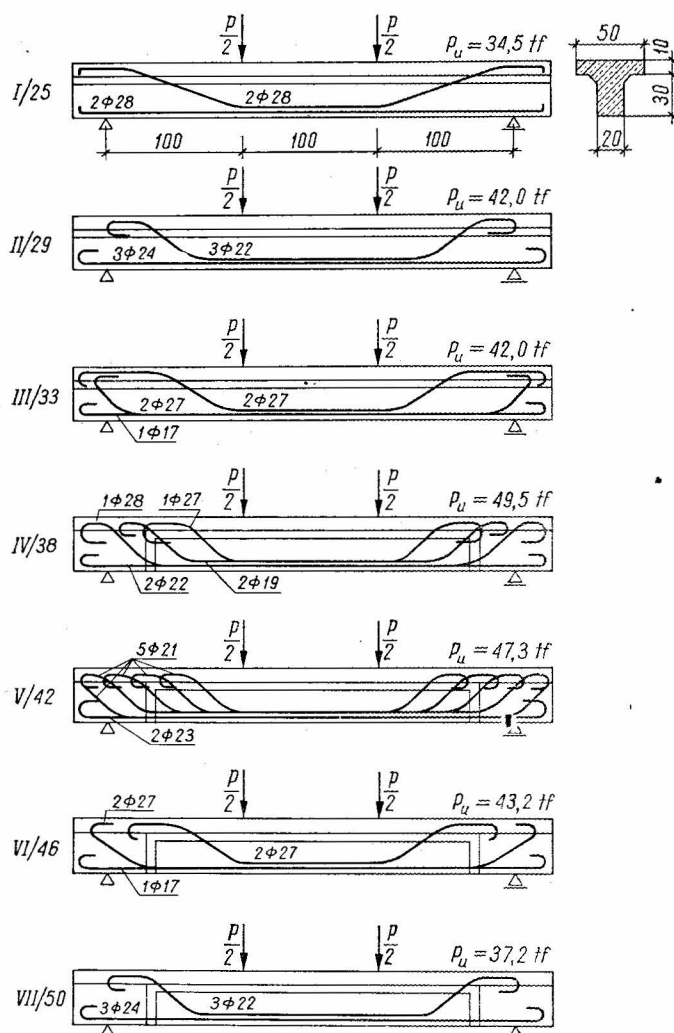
Poutres dans les essais de DAFÉ, cahier 12 [3]
